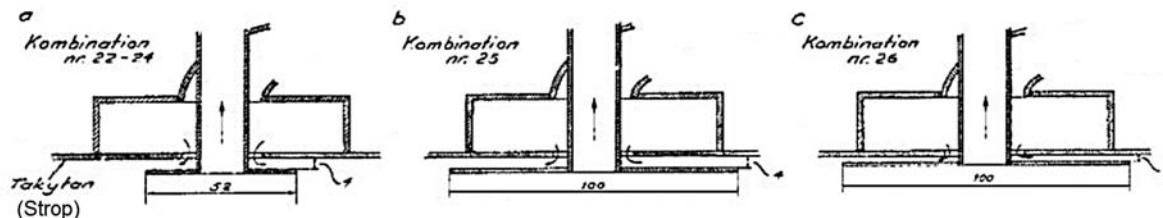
Zobrazení proudnic (Krejčí 2006) před:
